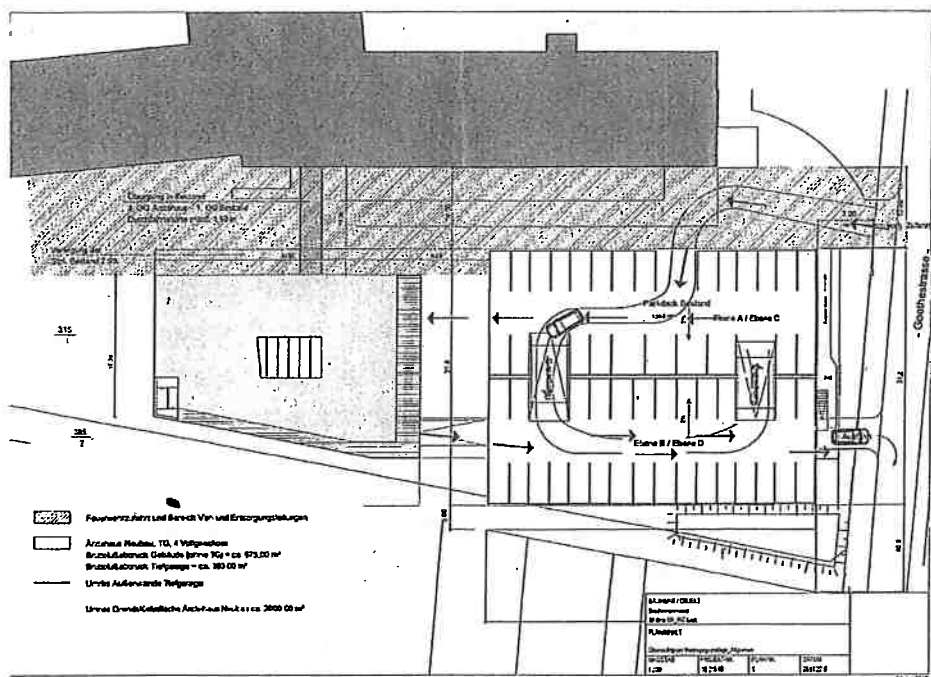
Lageplan mit Grundriss der Klinik, Parkdeck und Ärztehaus
